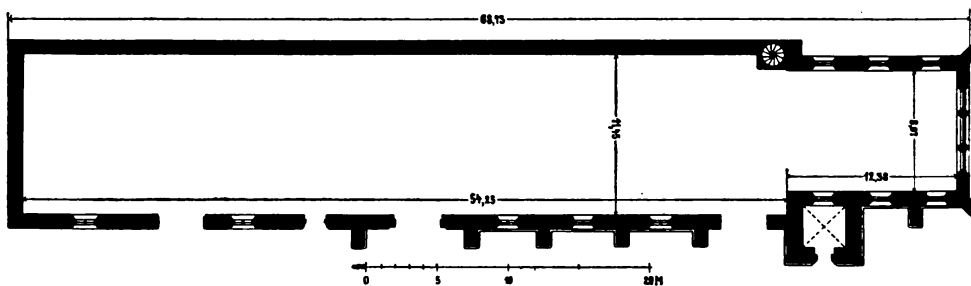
Franziskanerkirche in Mühlhausen, Grundriß.
